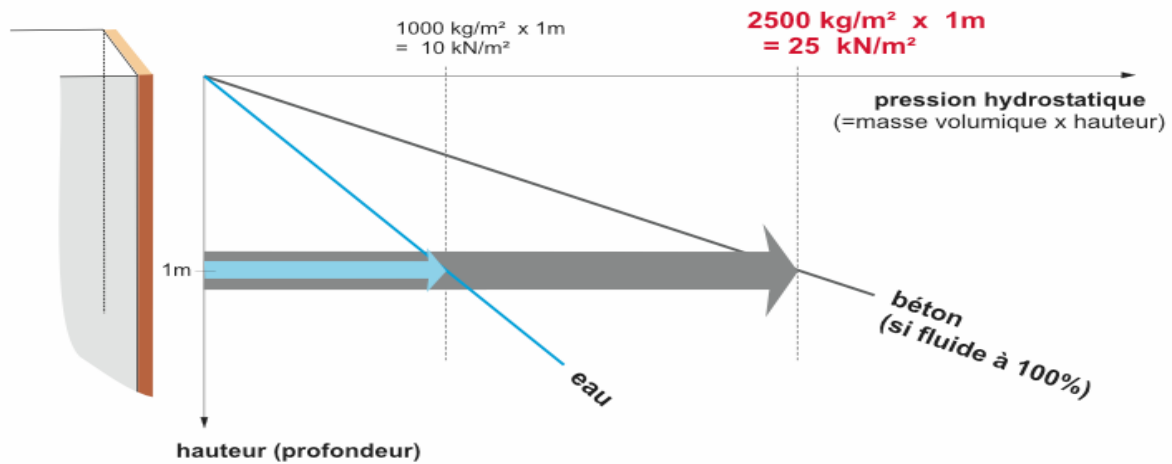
Pression horizontale exerçant sur le coffrage [3]
